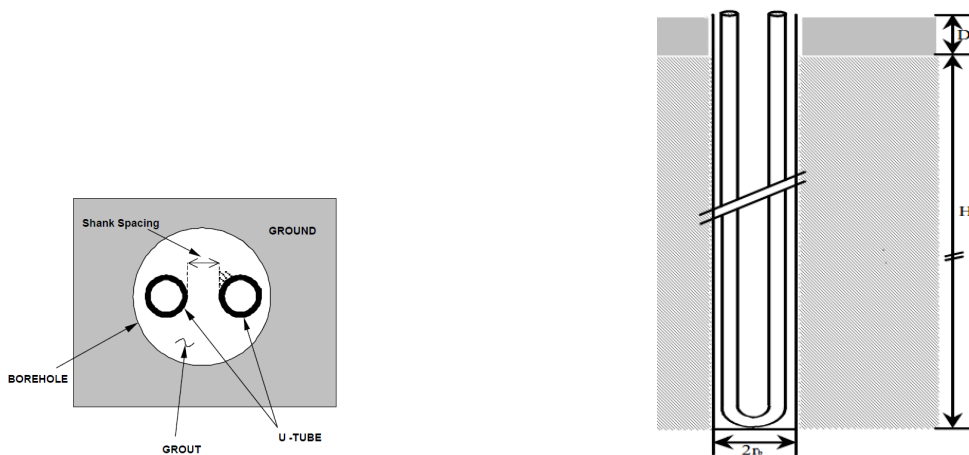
Scambiatore geotermico a sonde verticali: pianta e prospetto
